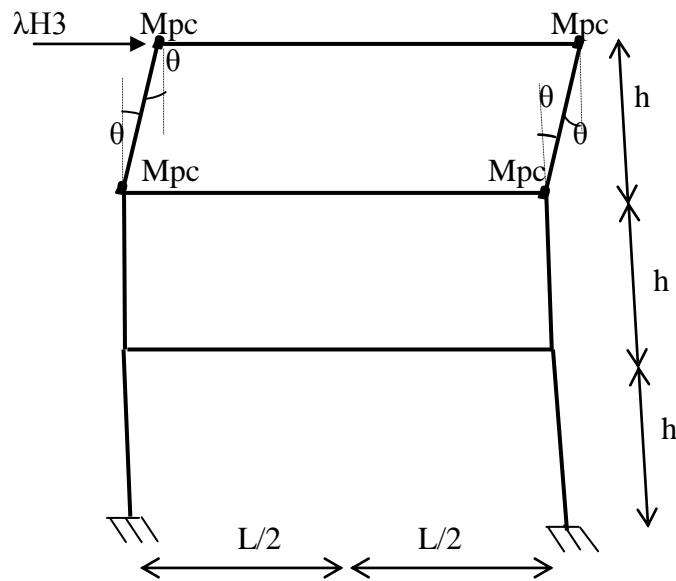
mécanisme N°6 des poteaux du 3eme niveau
